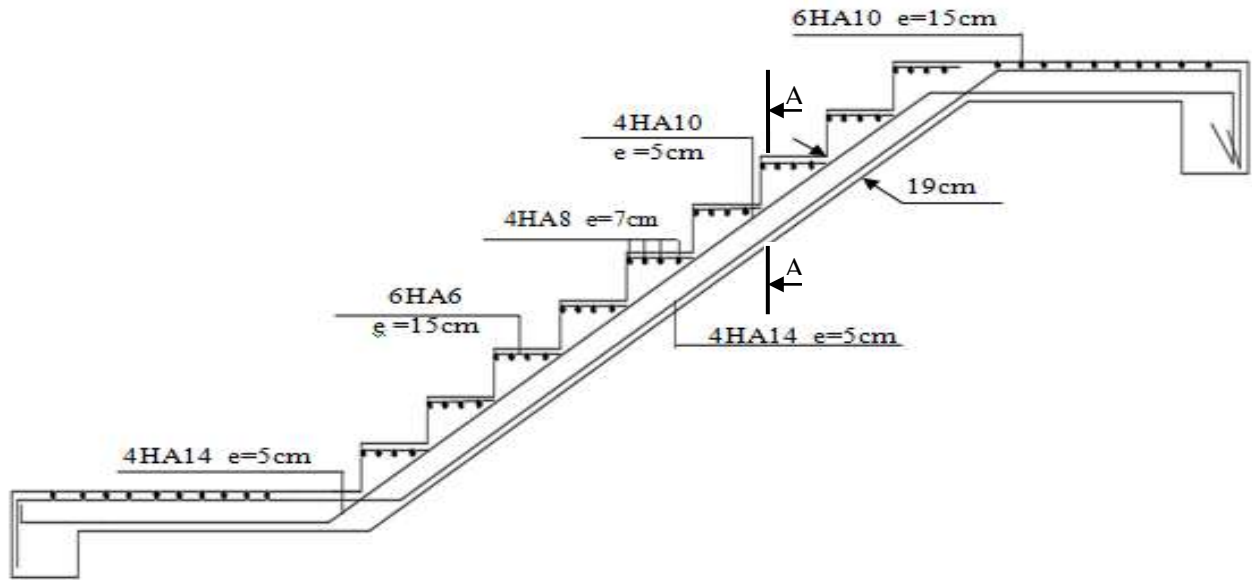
Schéma de ferrailage de l'escalier sur limon central.
